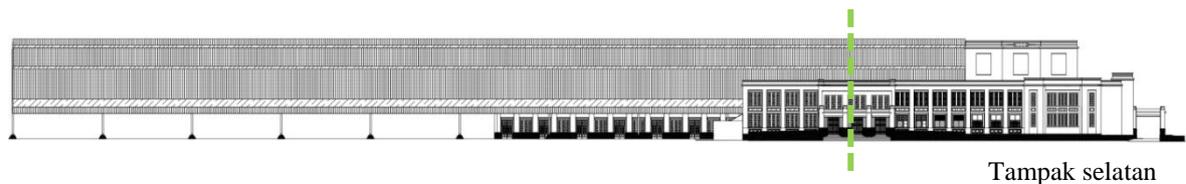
122 Simetri Bilateral Yang Terbentuk Pada Tampak Depan Bangunan
